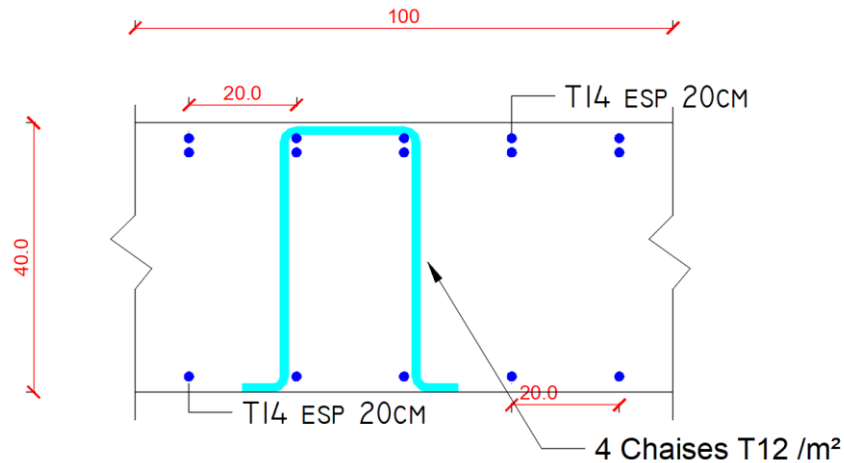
Ferrailage de la Dalle du Radier.
